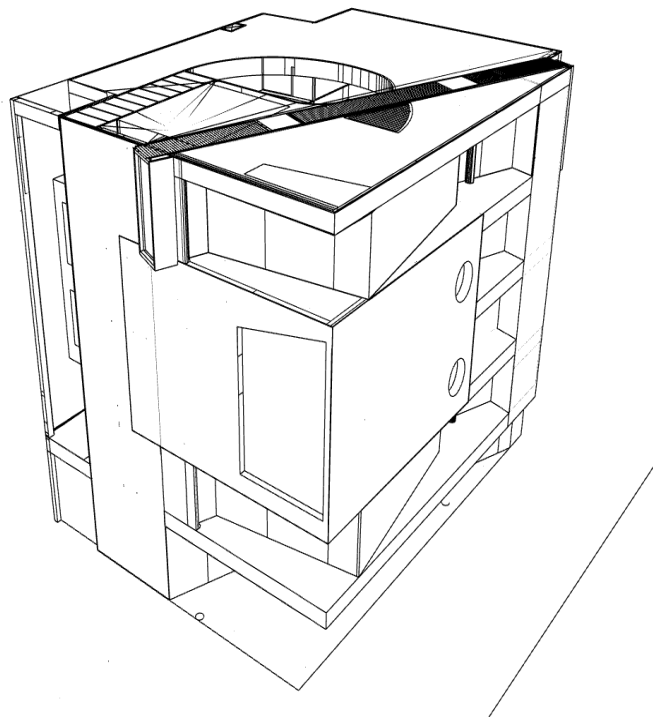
Axonometría incluye las dos fachadas y la cubierta
